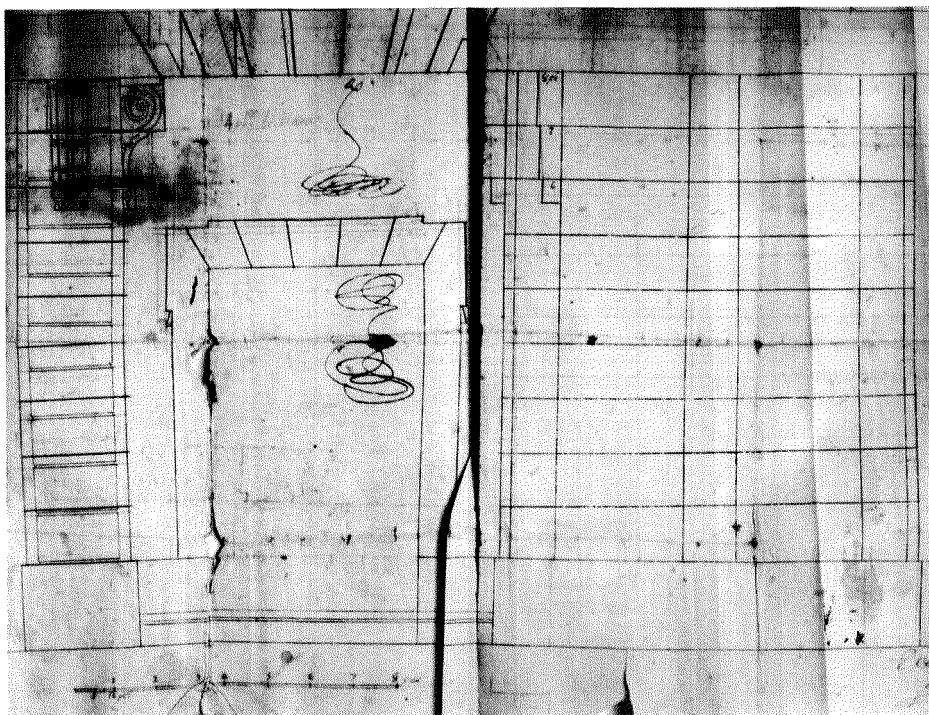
Monte para el primer soportal a la Marina con su puerta en la planta baja. Elexalde, Julio de 1779 (A.G.M.S.).
